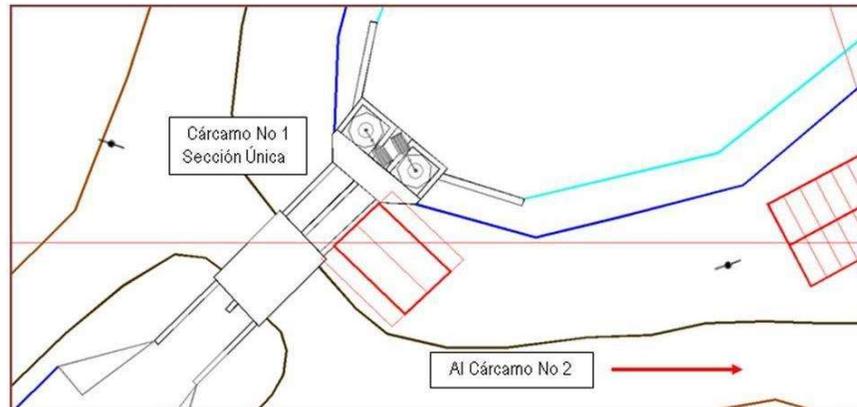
Planta general del cárcamo No. 1. (Guillen, 2008).
